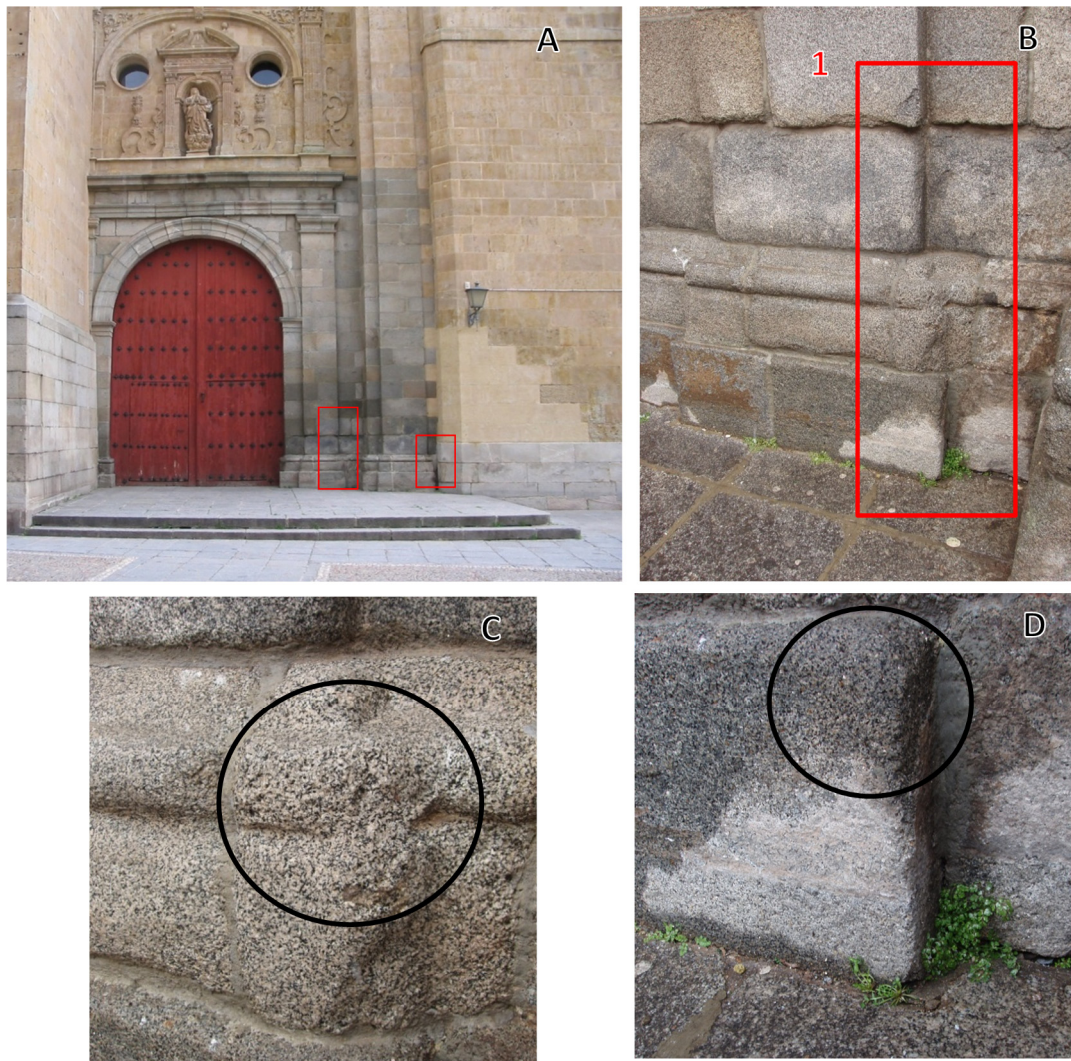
Lugar de muestreo de CDW y CMW en la Portada Principal de la Catedral Vieja de Salamanca. A: Vista de la puerta con las dos columnas donde se ha muestreado (1 y 2). B: Detalle de la columna 1. C: Lugar exacto de toma de la muestra CMW en la columna 1. D: Lugar de muestreo de CDW, en la columna 2.
